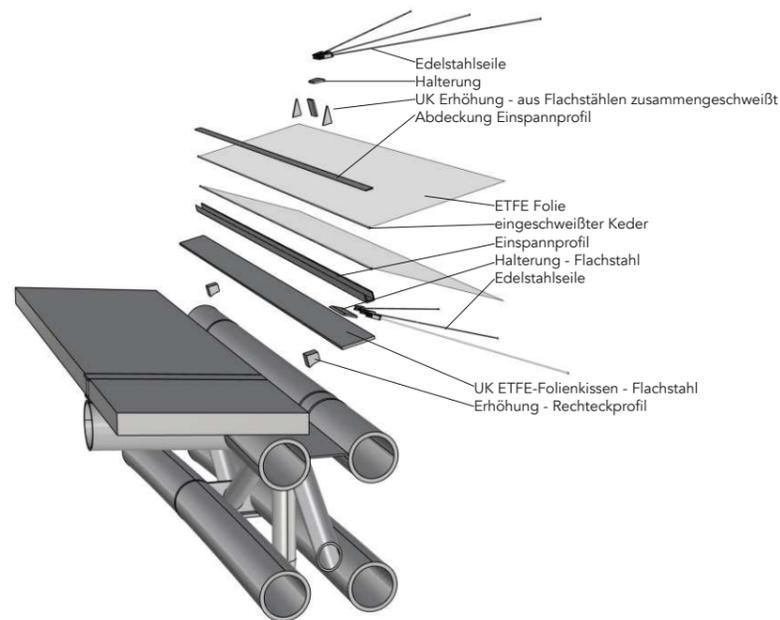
Explosionszeichnung ETFE-Folienkissen
